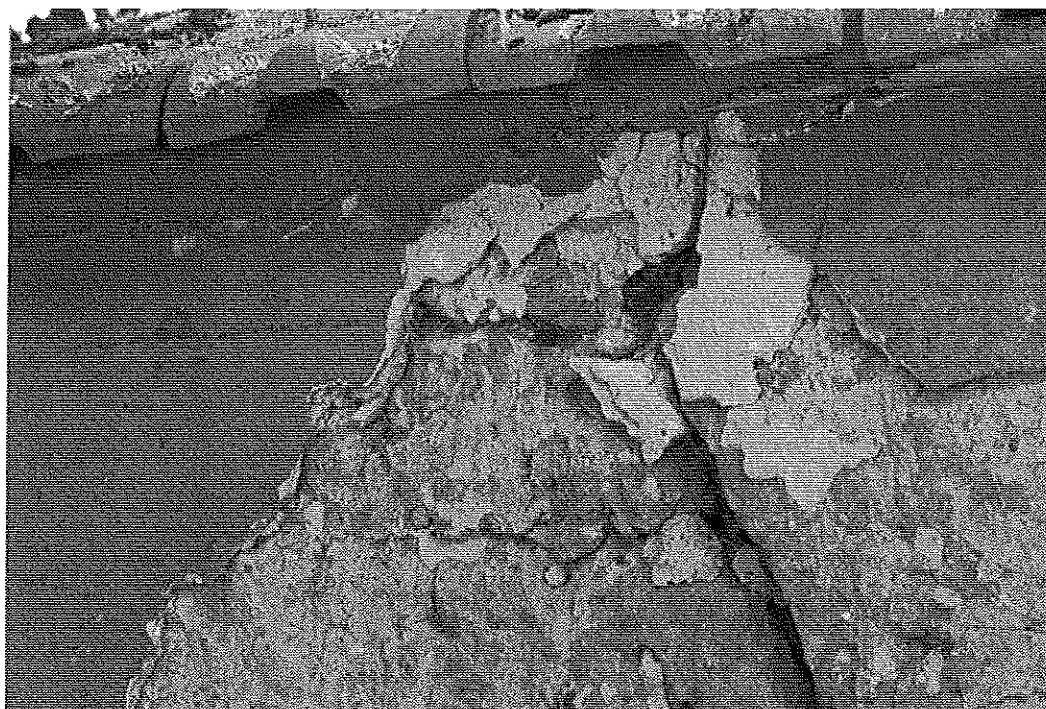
Fissuration d'un mur de clôture en pisé avec décollement de l'enduit. © J. Putatti
